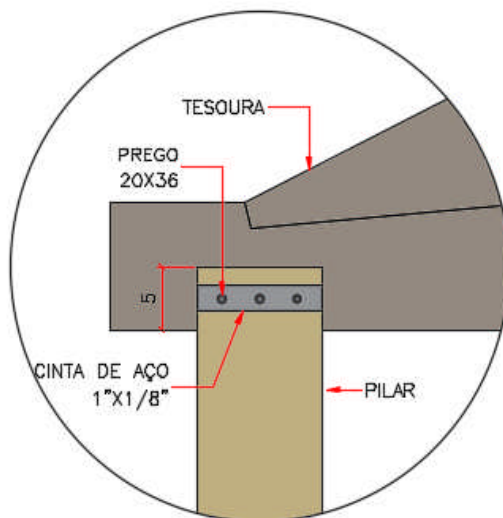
LIGAÇÃO ENTRE PILAR E TESOURA
